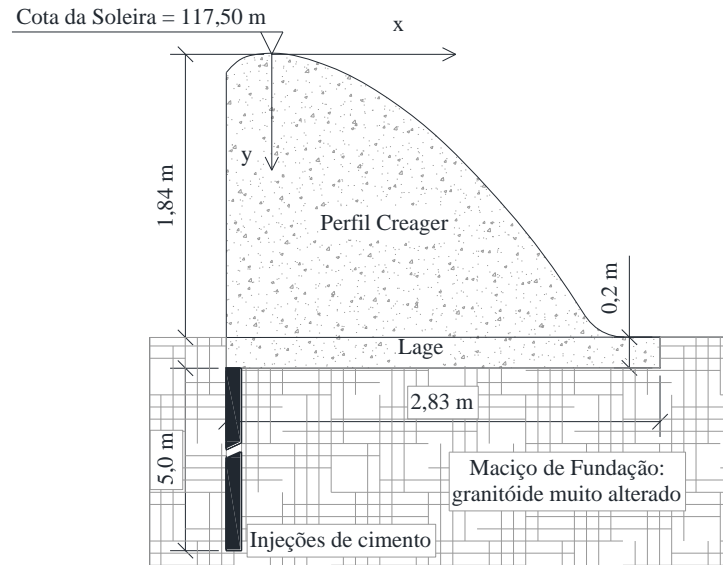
Seção transversal para a Alternativa 2 de projeto para o vertedouro em perfil Creager
